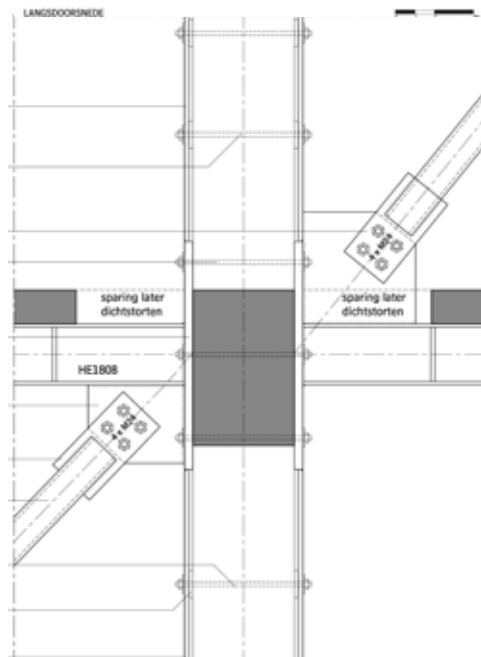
Detail Fassade u. Schnitt © Luechinger Architects
